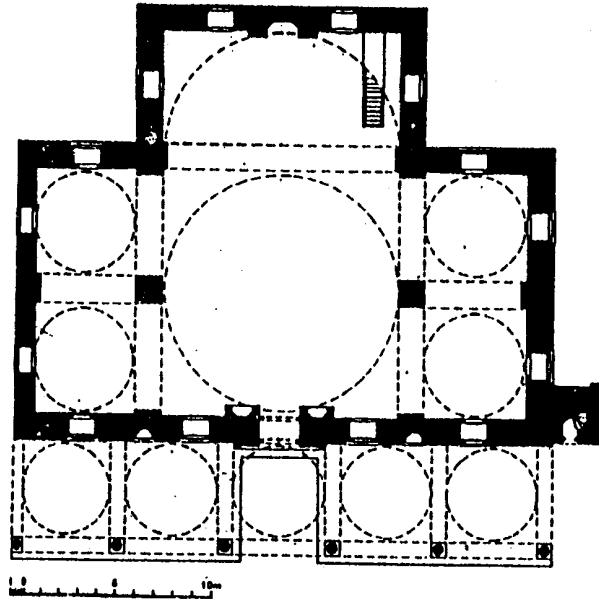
مسقط أفقي لجامع السنانية بدمشق
